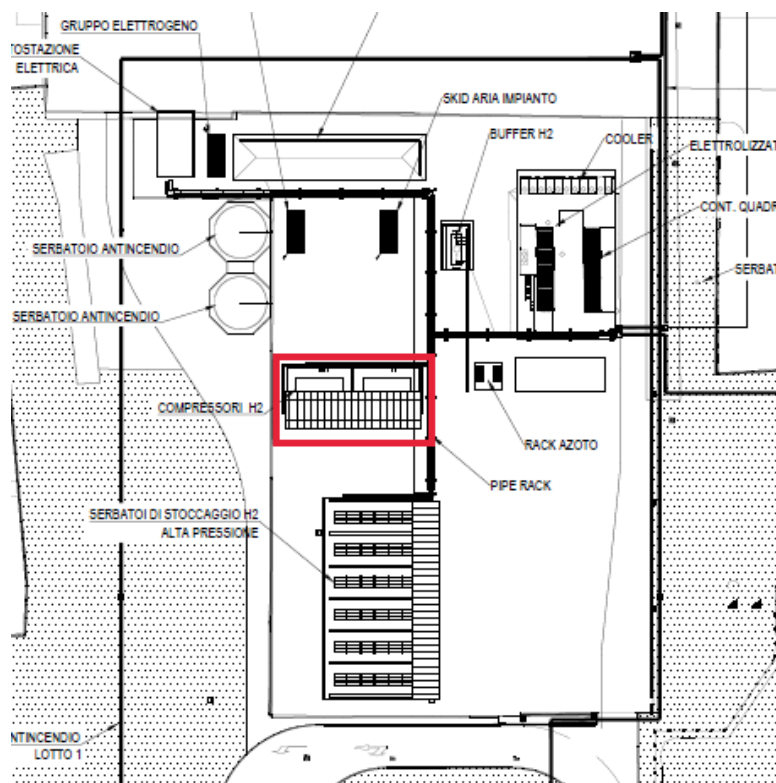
Individuazione planimetrica del box Compressori nel Lotto 1
